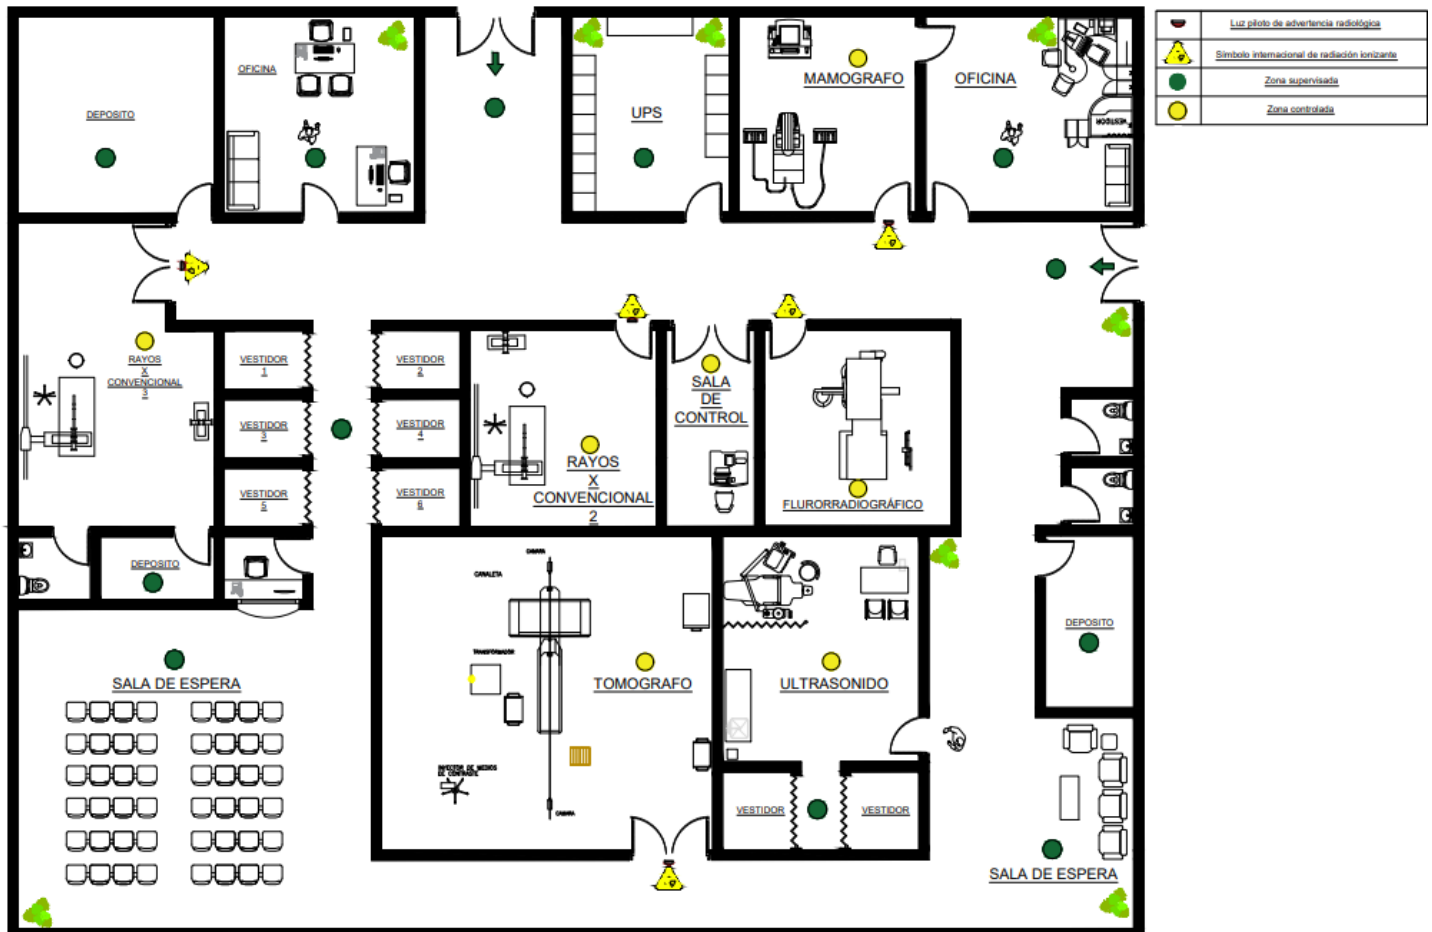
Plano del Departamento de Imagenología en 3D – Creado en AutoCAD.
